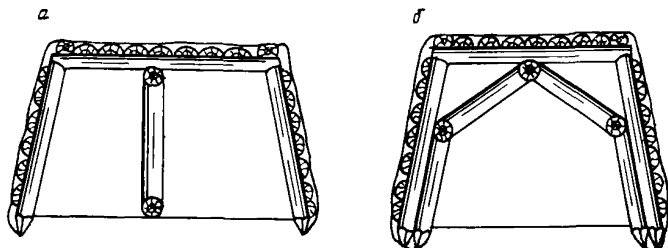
Деревянные крепежные рамы усиленной конструкции: а - с дополнительной стойкой и прогонами; б - с подкосами и прогонами
